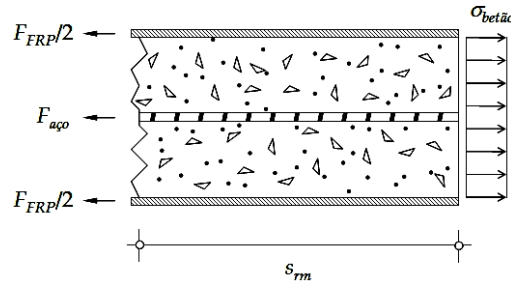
Equilíbrio das forças num elemento de betão armado e exteriormente reforçado com FRP submetido à tracção.
